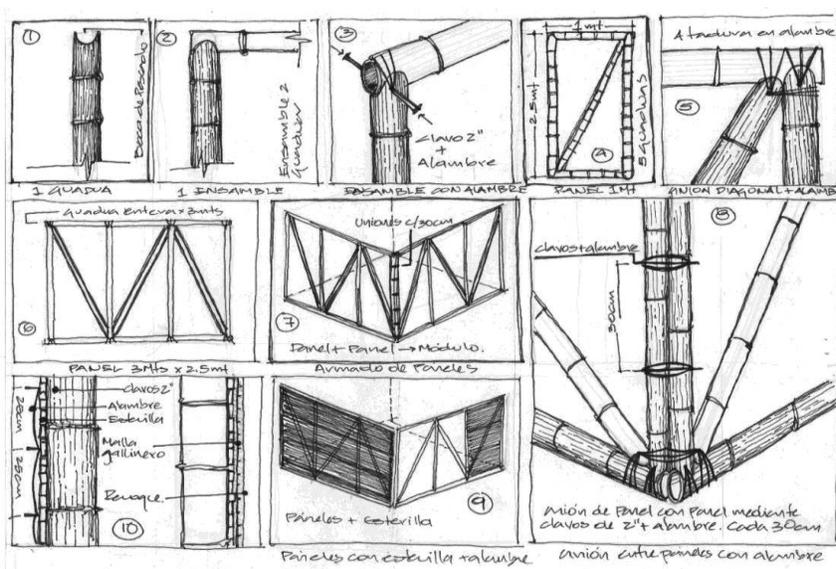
Detalles constructivos planteados para la propuesta. Fuente: Autor.
